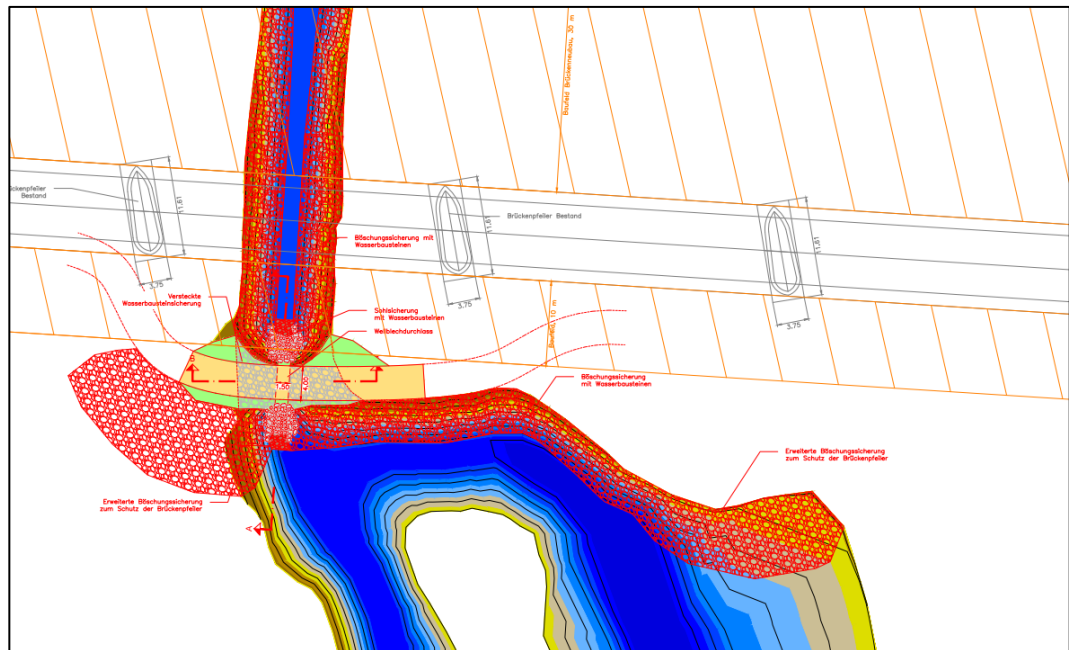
Lageplanausschnitt der geplanten Stillwasserquerung
